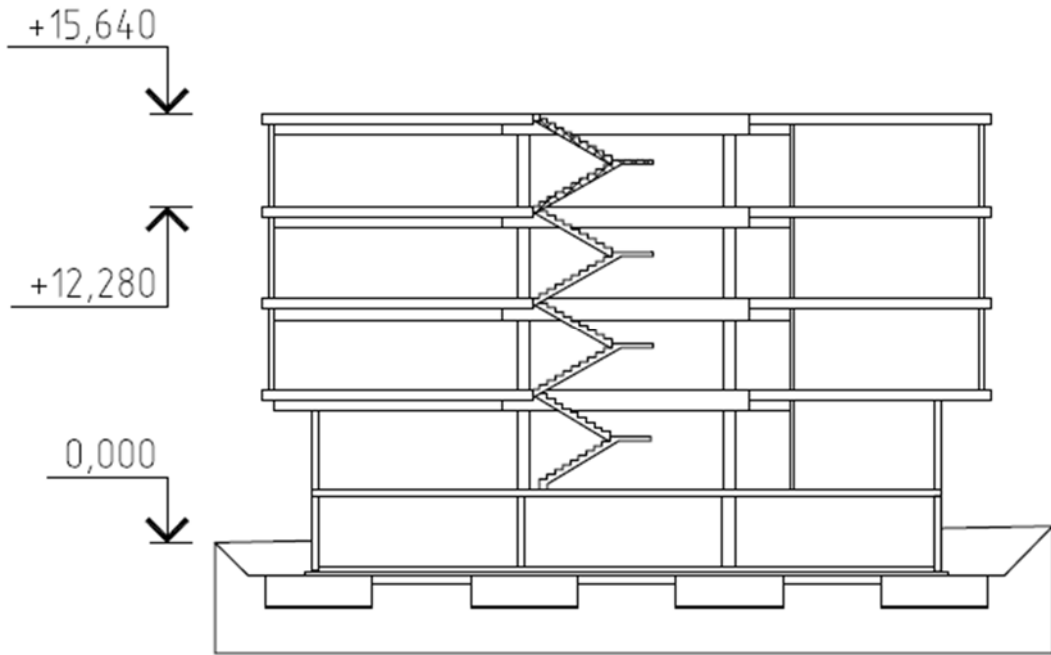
Schéma betonáže železobetonových stěn a sloupů 4. NP
